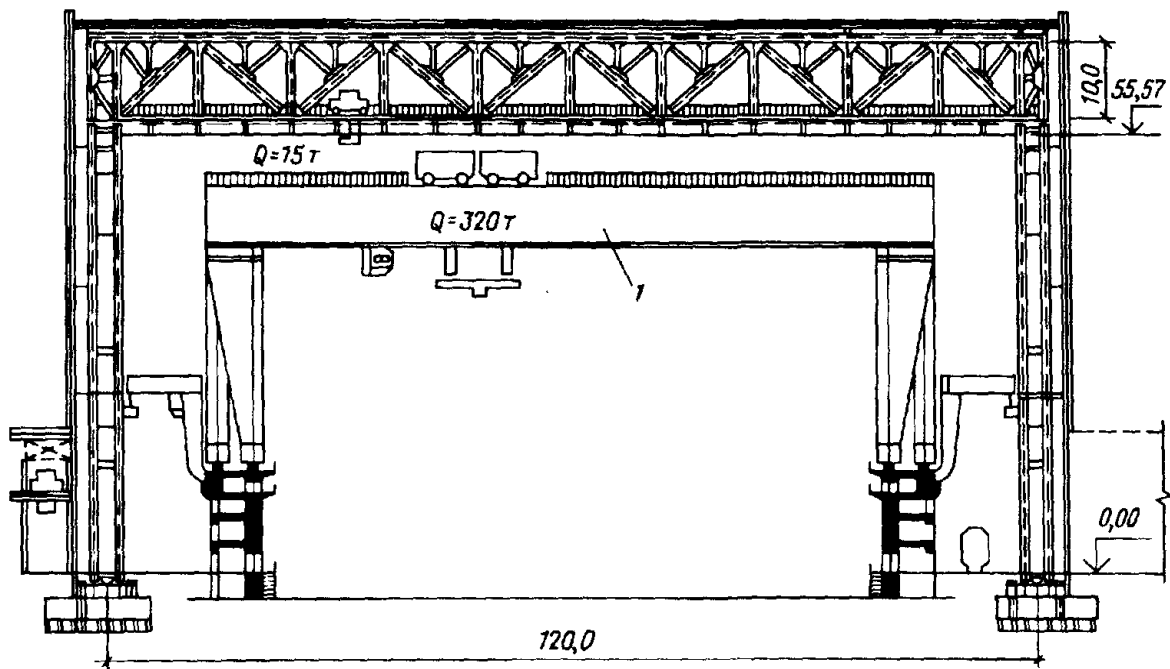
Унікальна поперечна рама виробничої будівлі
